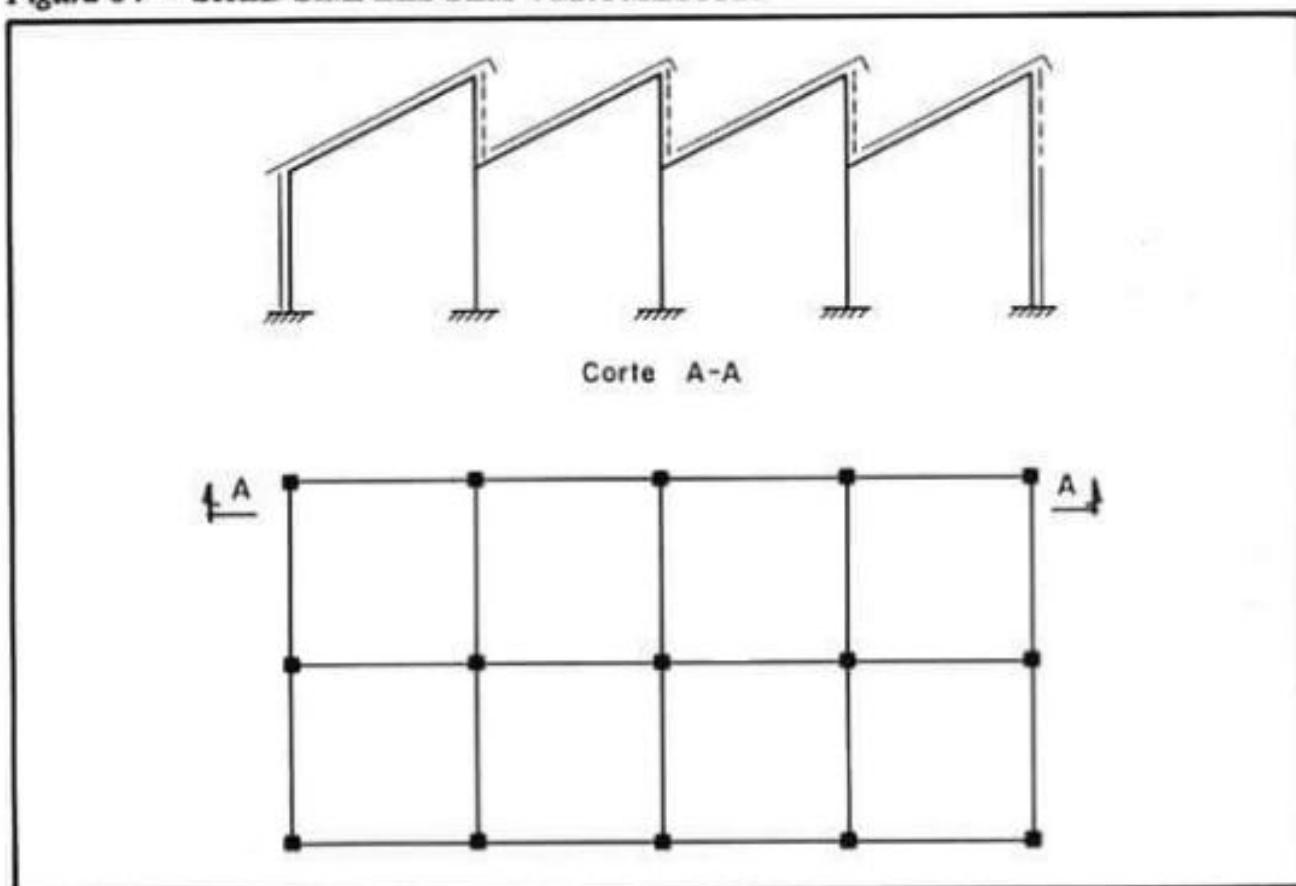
SHED SIMPLES SEM VIGA MESTRA
